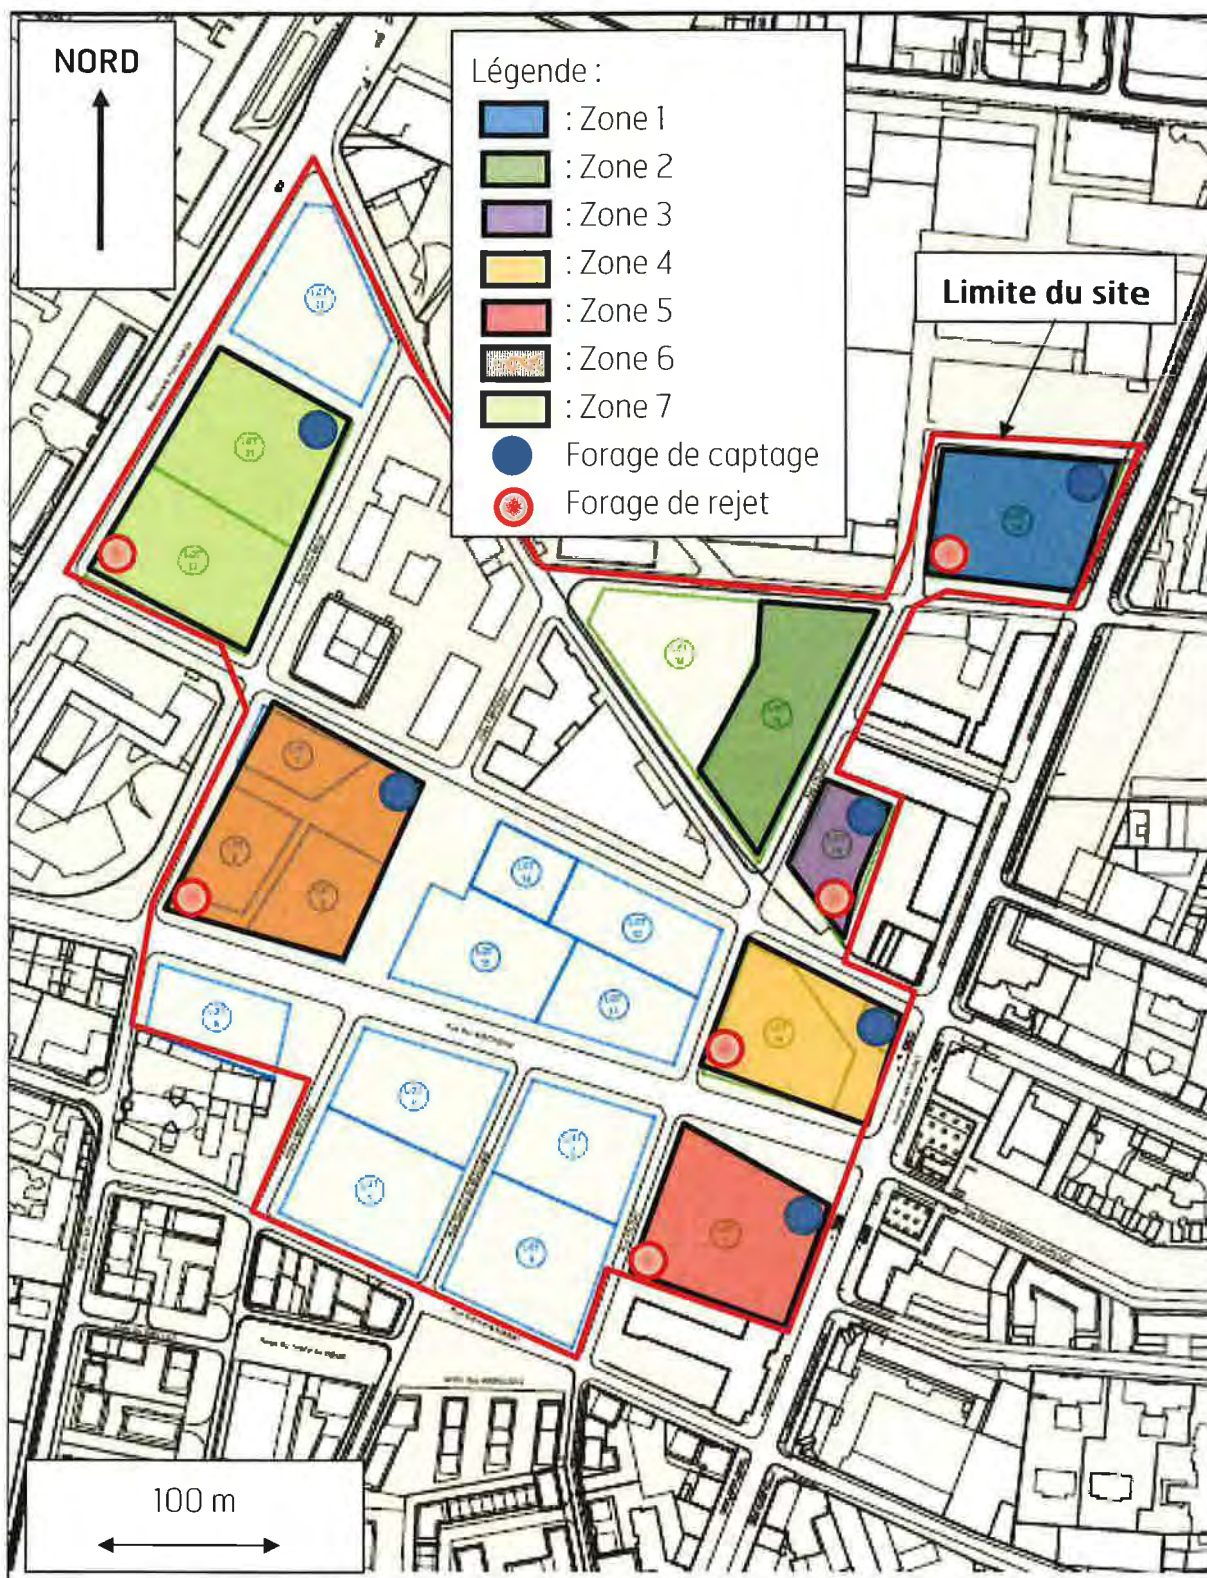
Plans d'implantation prévisionnelle des ouvrages géothermiques : Scénario n°3
